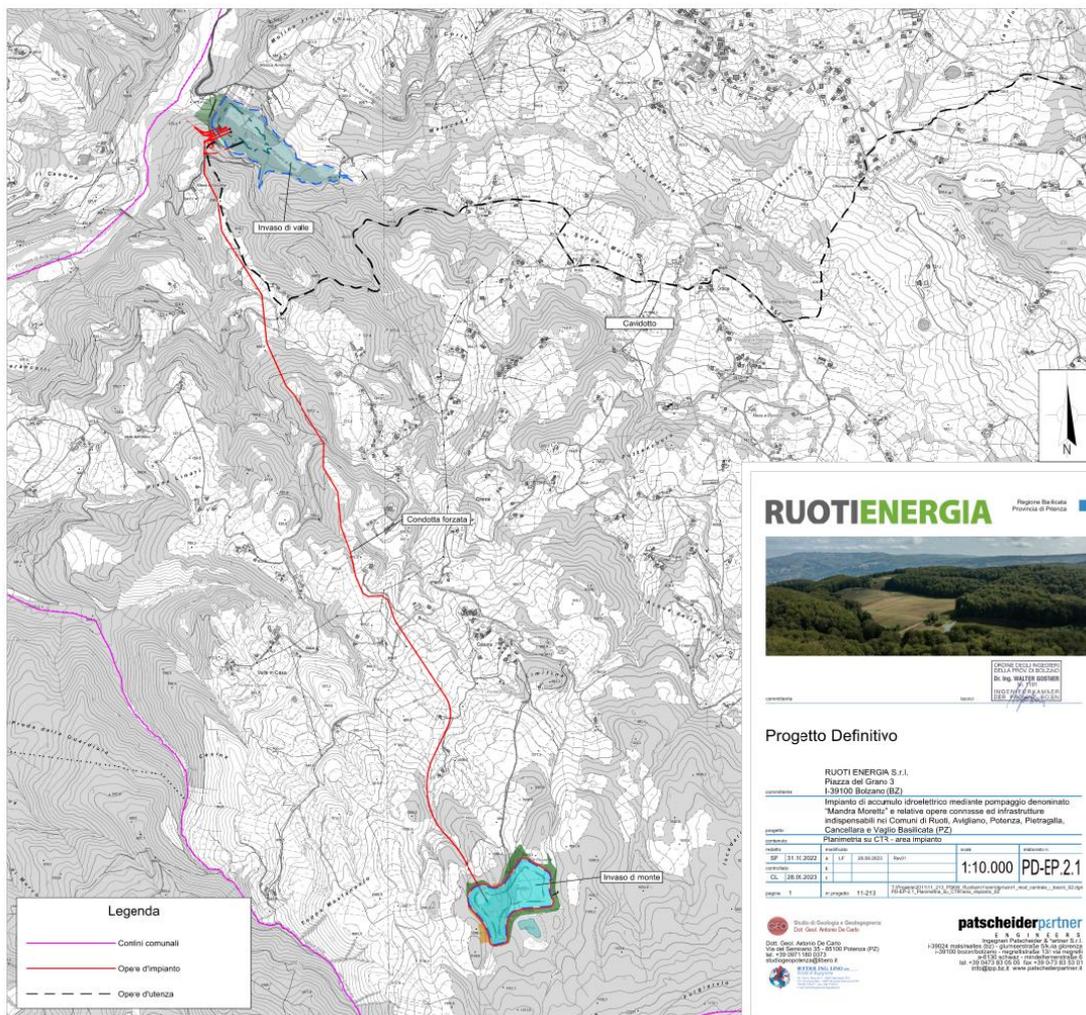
Planimetria su CTR dell'area di impianto (elaborato PD-EP.3.1 del progetto definitivo)
